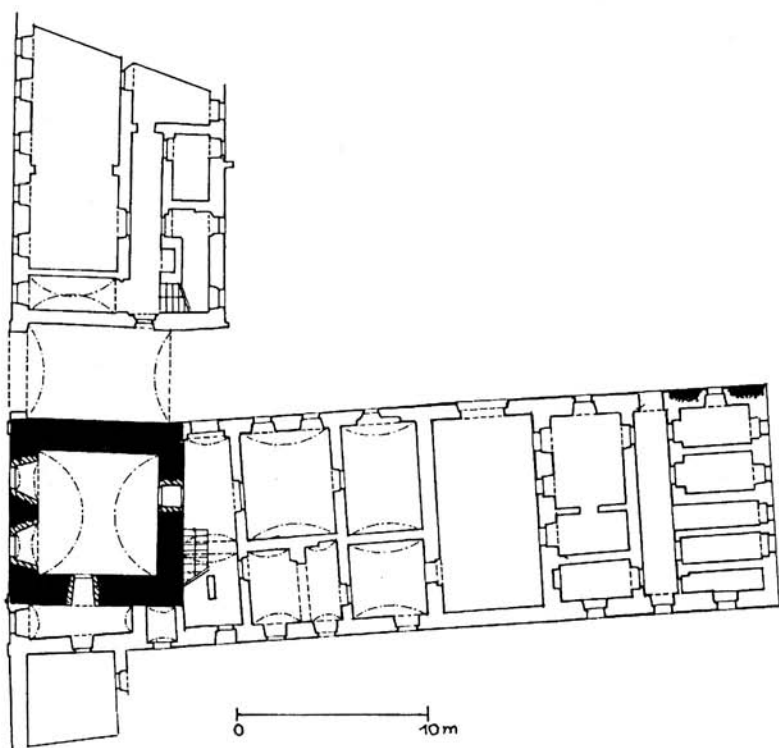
Jilové. Grundriss des heutigen Rathauses mit dem mittelalterlichen Wohnturm (schwarz). Zeichnung: P. Chotěbor.
